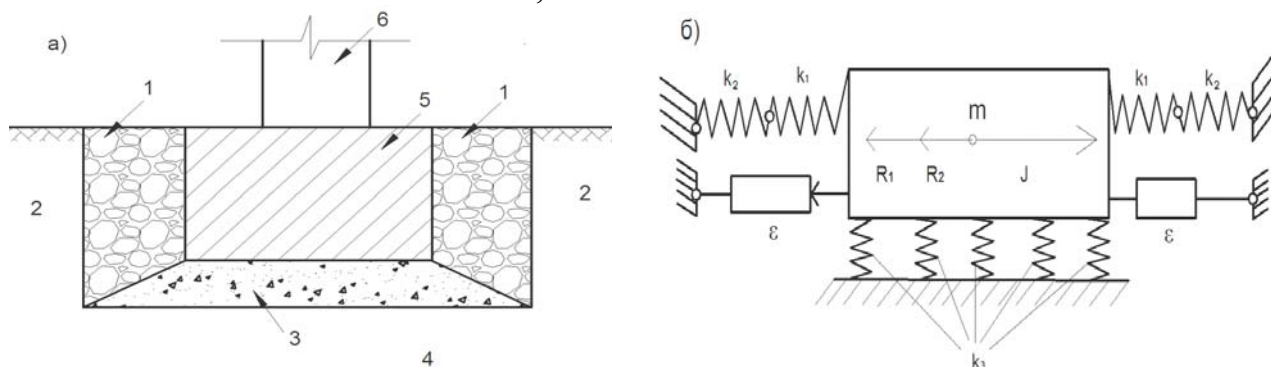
Конструкция фундамента с основанием и расчетная схема.
